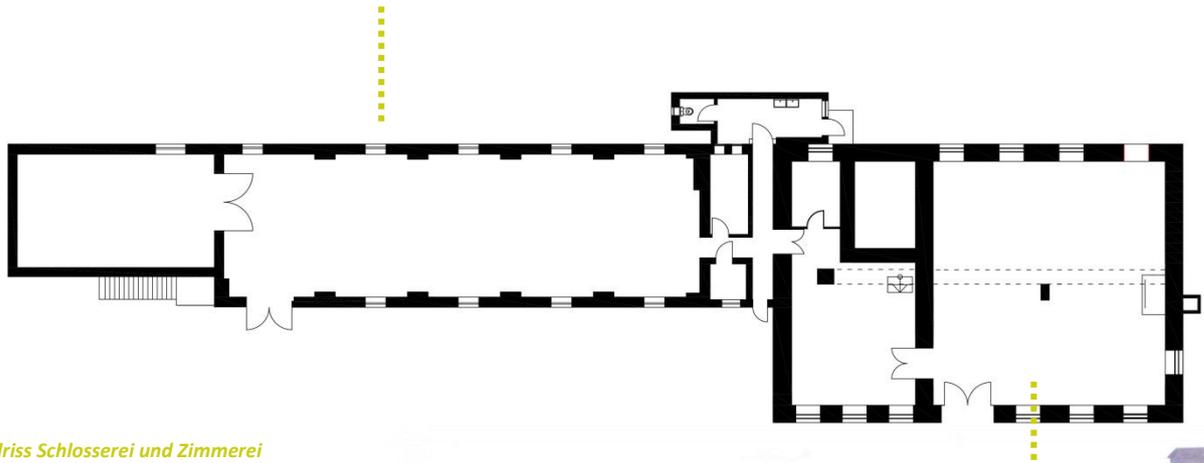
Grundriss Schlosserei und Zimmerei
